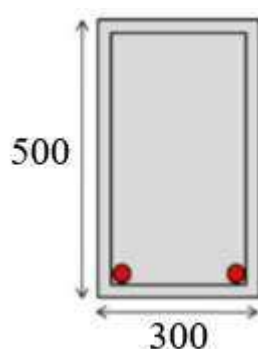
Dimensões da viga com armadura positiva (em mm)
